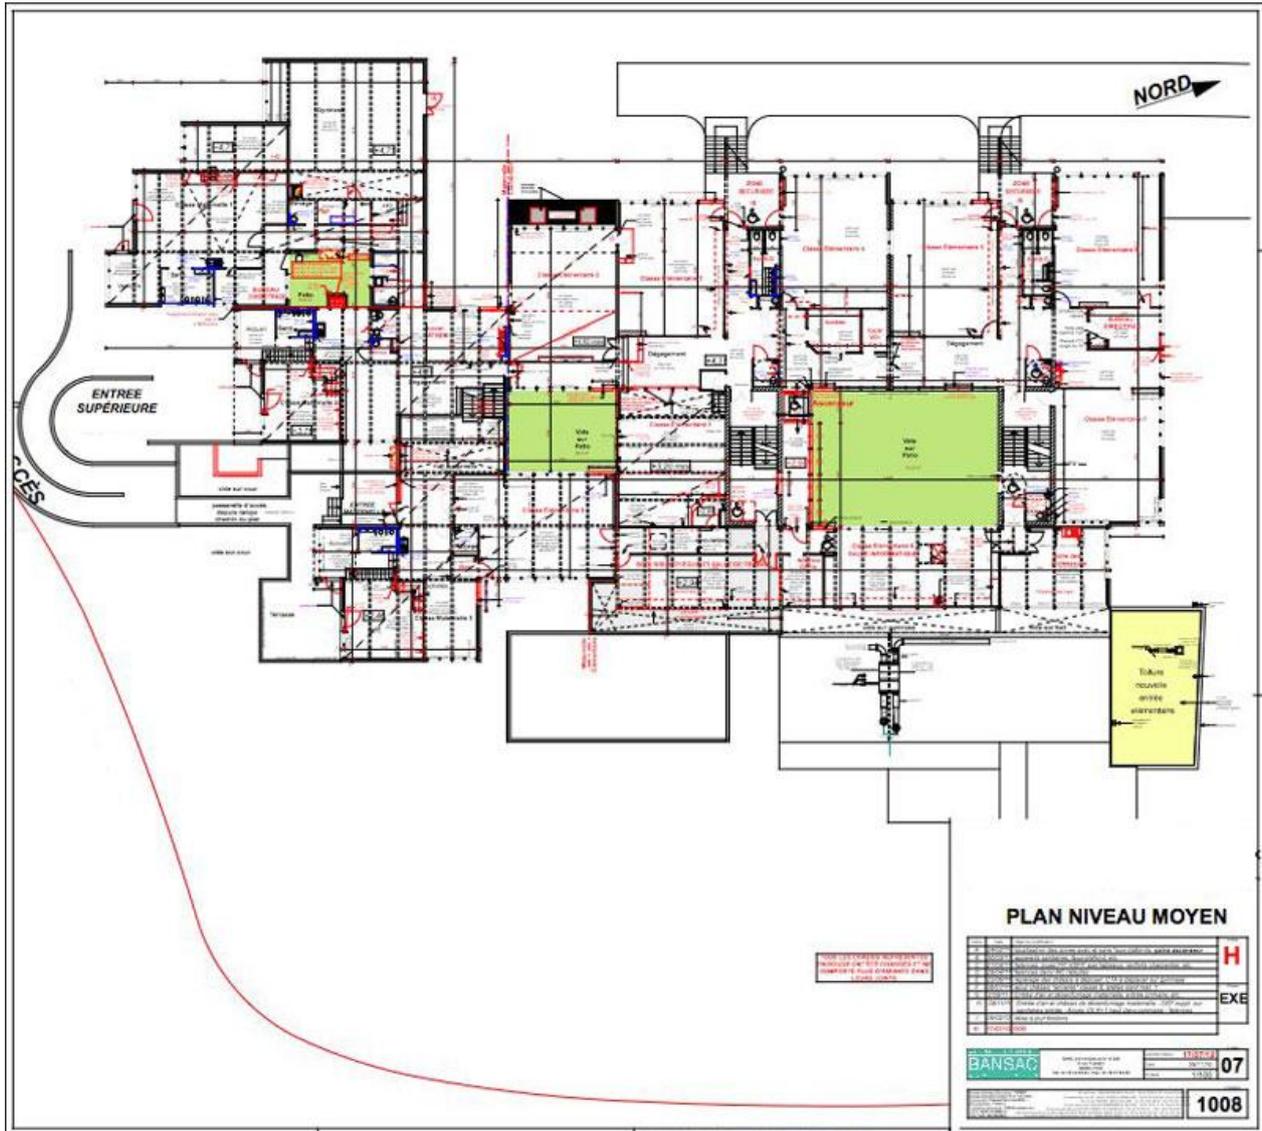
Exemple d'un plan d'exécution d'un niveau de bâtiment
